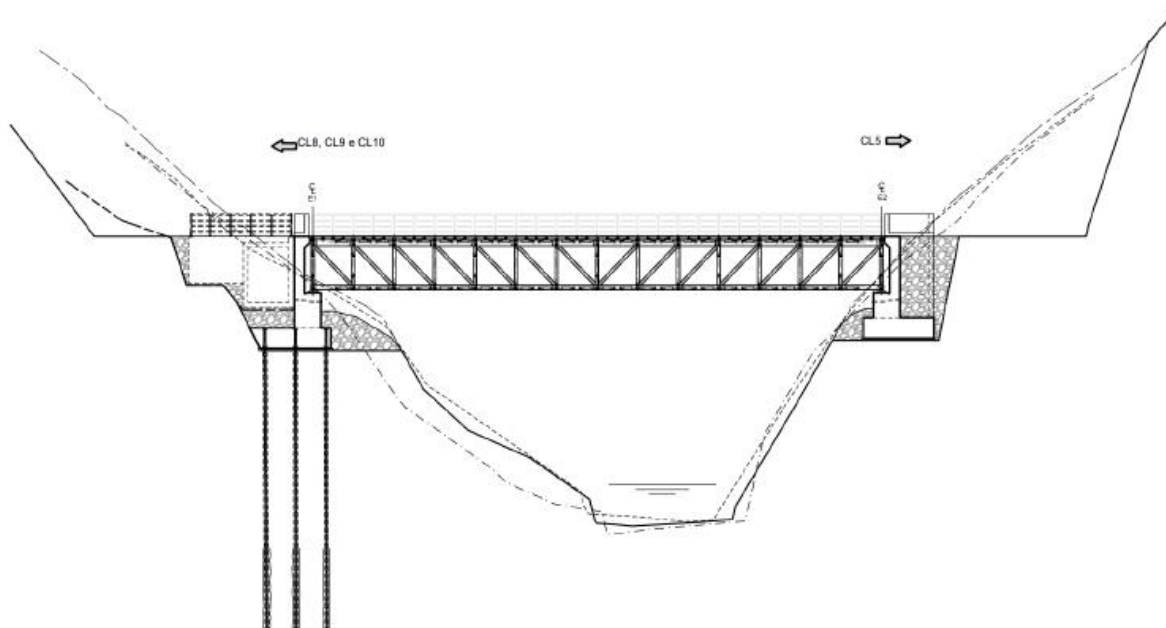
Fase IV: Execução da Ponte metálica e instalação de equipamentos
